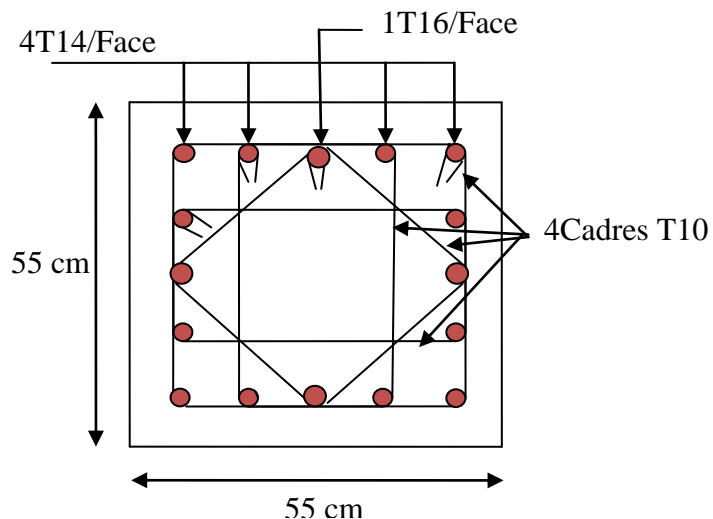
Schéma de ferrailage des poteaux de 3^{ème} ,4^{ème} étage
